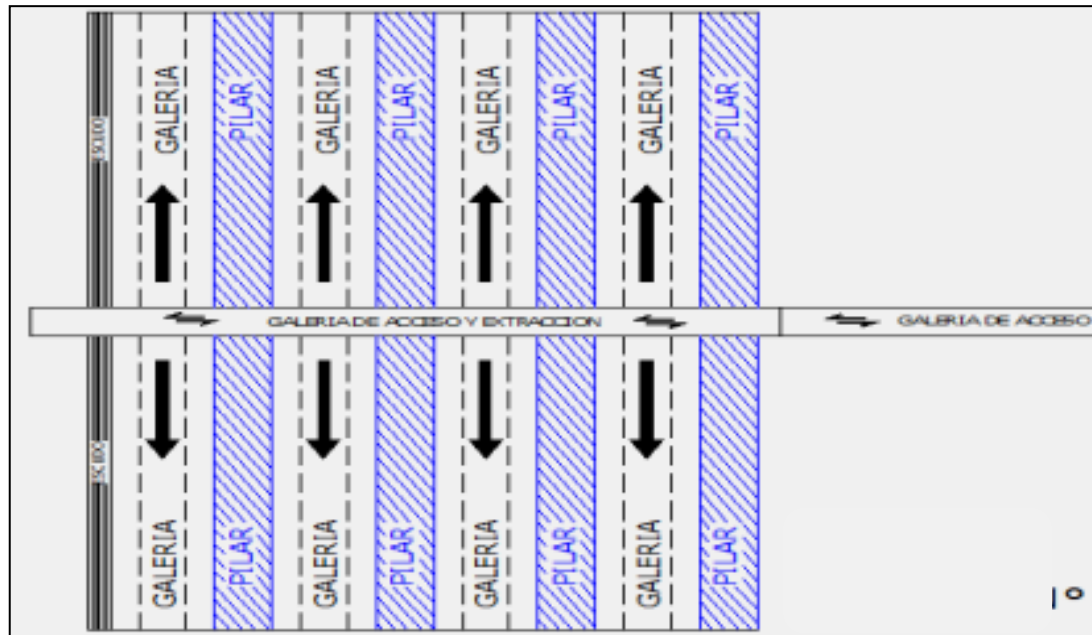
Preparación a partir de la Galería de acceso del cual se avanzan galerías transversales a éstas y paralelas entre sí de sección de 4 x 4 m y las ventanas para el Slot de sección 4.0 m x 4.0 m
